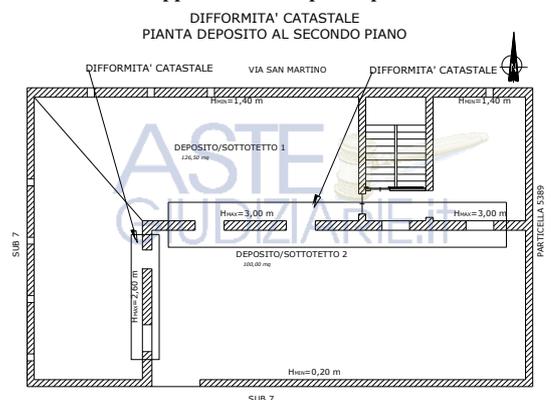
planimetria delle difformità catastali deposito sottotetto al secondo piano
